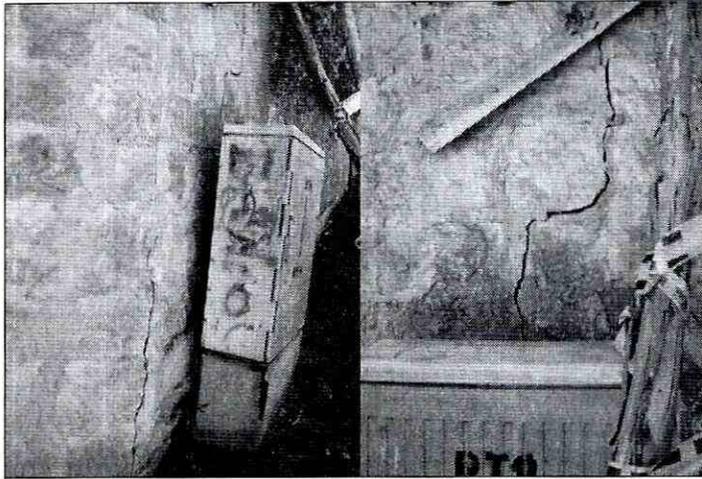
Daños existentes hacia el costado norte de la vía Calle 147 B a la altura de la Carrera 89 (al frente del predio de la Calle 147B No. 89 – 46), asociados posiblemente con daños del sistema y deficiencias constructivas en la red de alcantarillado. Fotografía del 6 de Septiembre de 2011
